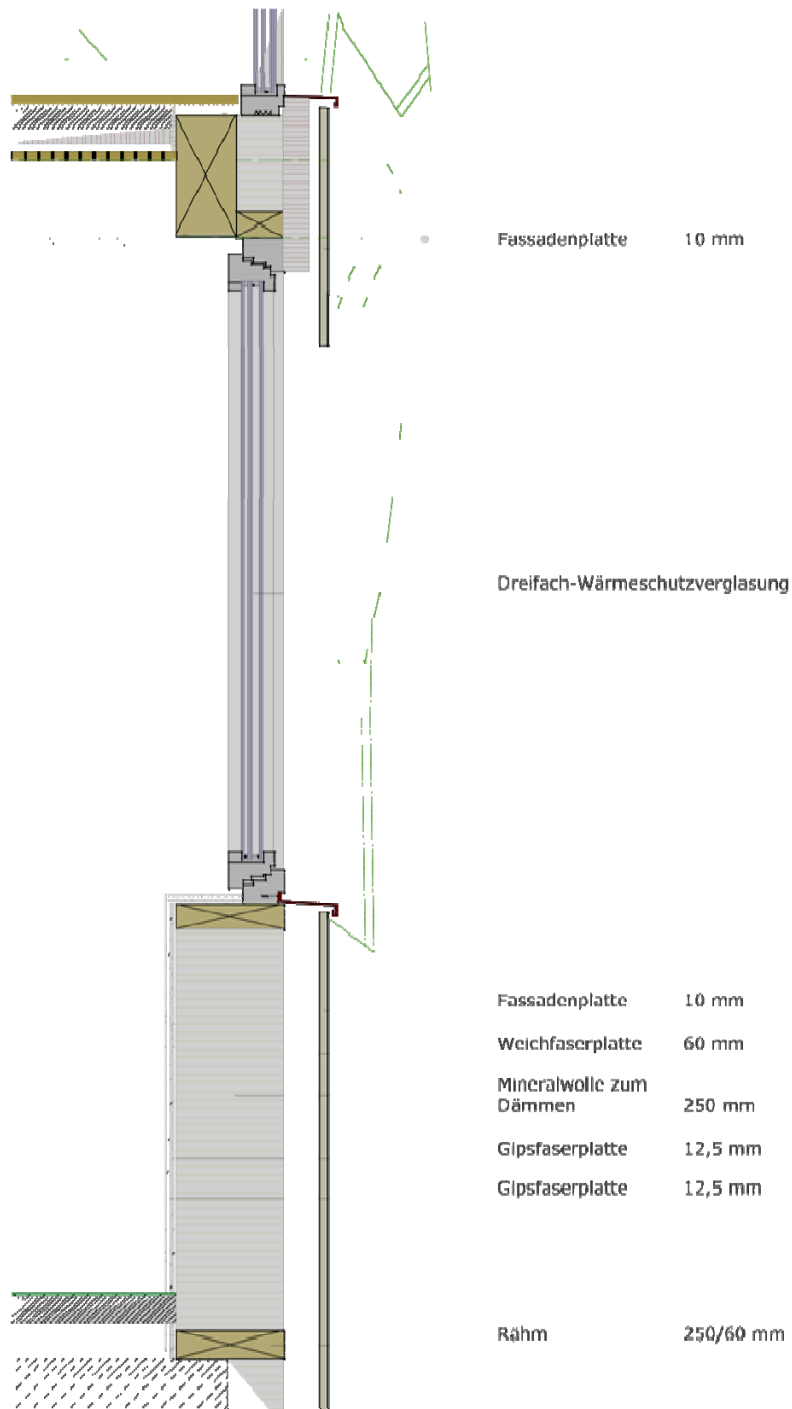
Schnitt Außenwandaufbau Minimum Impact Haus, o. M. , Quelle: DGJ
